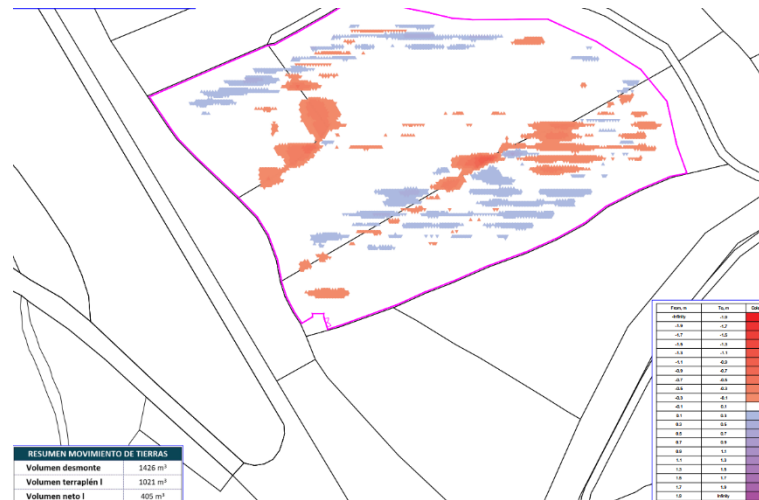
Emplazamiento zonas acondicionamiento terreno
